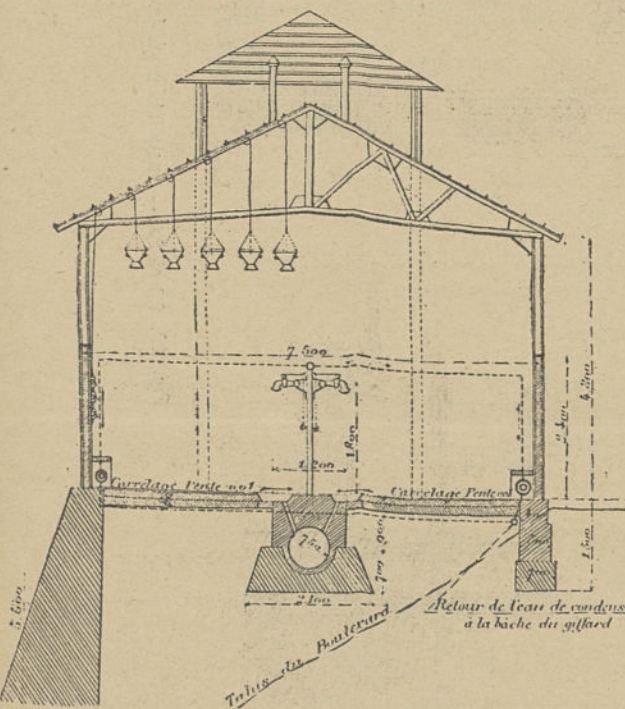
Coupe transversale du lavabo des ouvriers.
